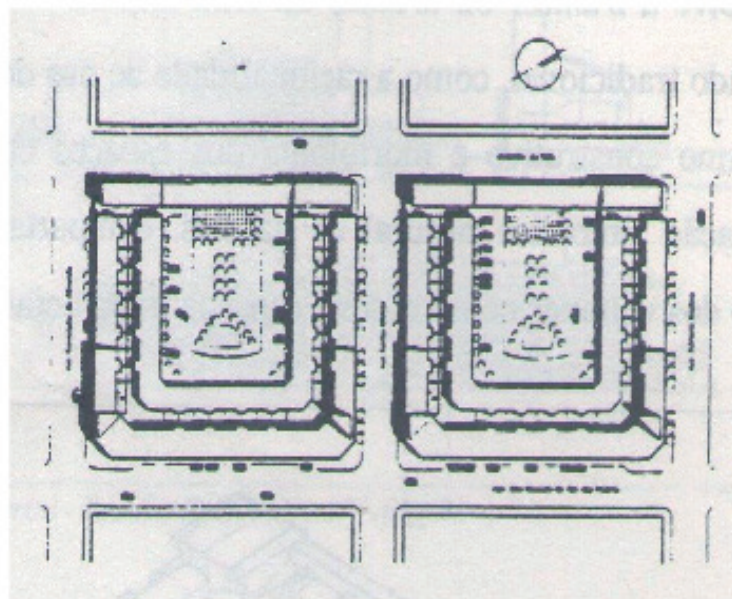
Implantação e Fachada Vila Mara – São Paulo – Arq. Padovano e Viglicca
